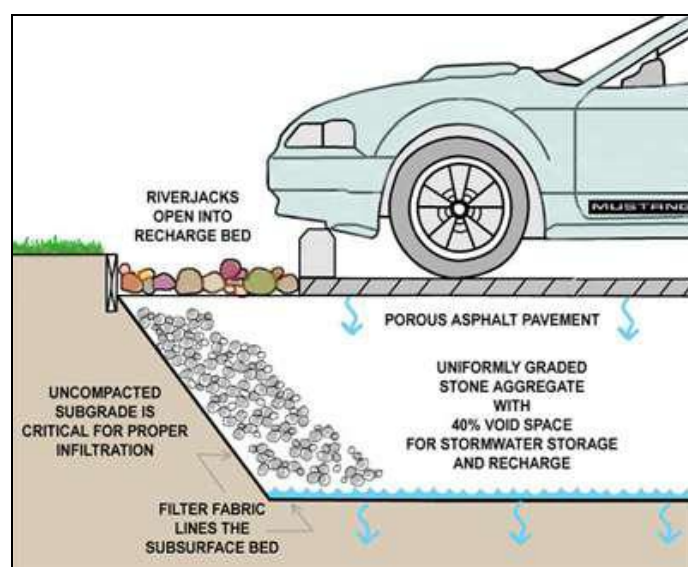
Funzionamento di un parcheggio con pavimentazione porosa [Pennsylvania Stormwater Management Manual]
